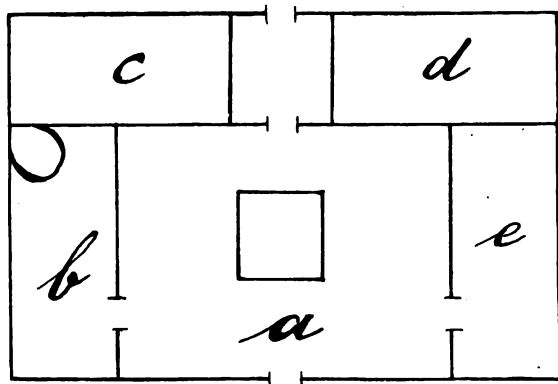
Haus des Gärtners auf dem Plan von St. Gallen.
